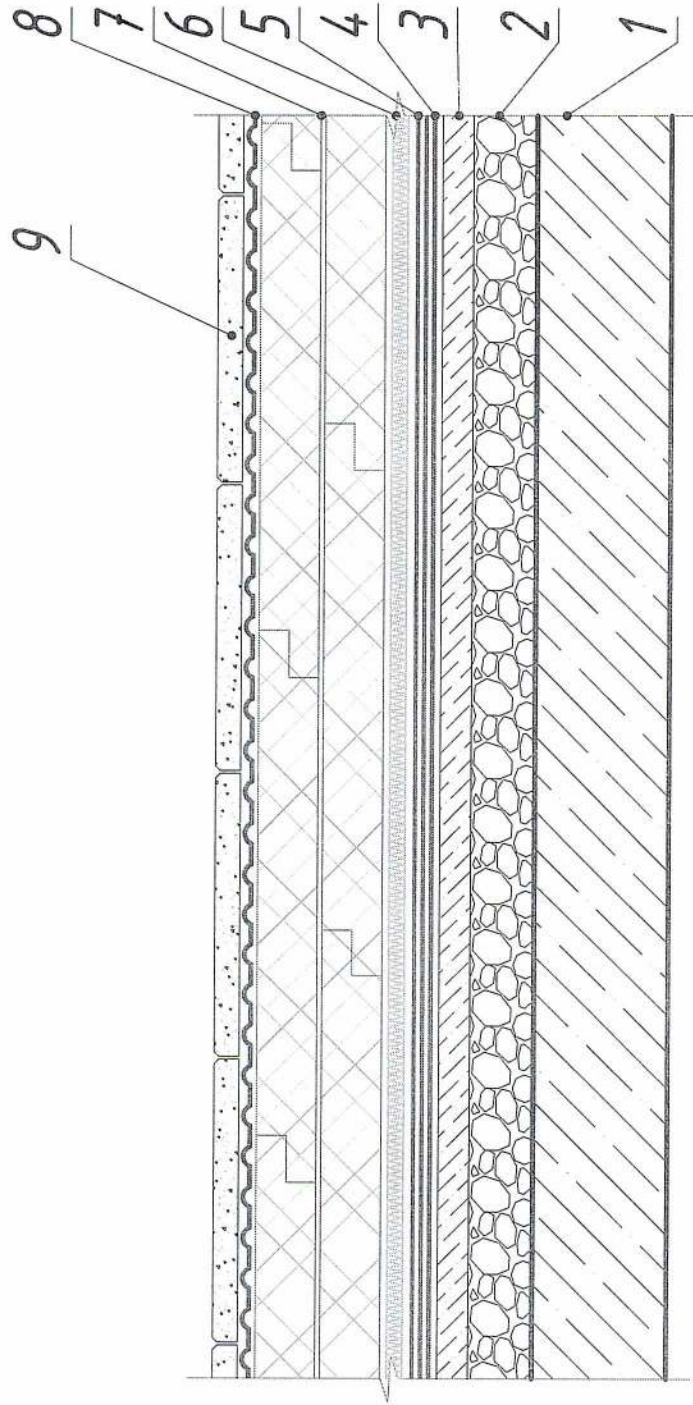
Принципиальная схема конструктивного исполнения бесчердачного покрытия выполняемого по железобетонному основанию (инверсионная кровля с балластом из тротуарной плитки)
